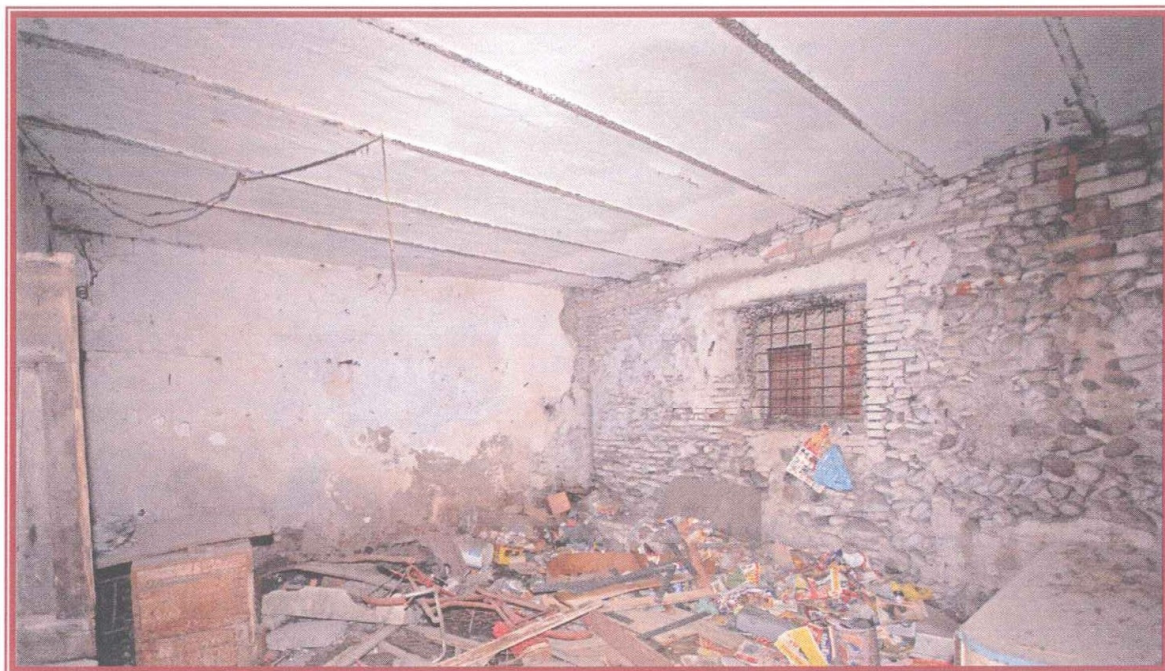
Vista della stalla a destra con copertura eseguita con travetti in metallo e voltini. La parete a Sud è completamente priva di intonaco.
